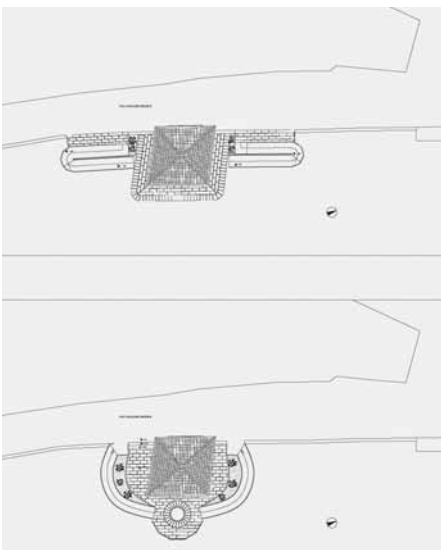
Planimetria della variante al progetto con evidenziazione della modifica alle rampe, resasi necessaria dopo il rinvenimento in corso d'opera di un muro in cemento armato di sostegno alla massicciata stradale.
